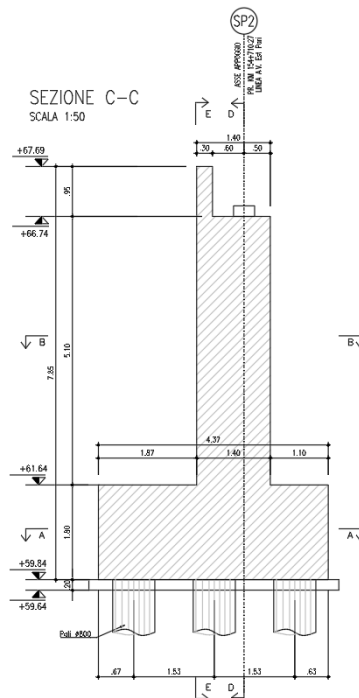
Sezione longitudinale spalla lato Verona
